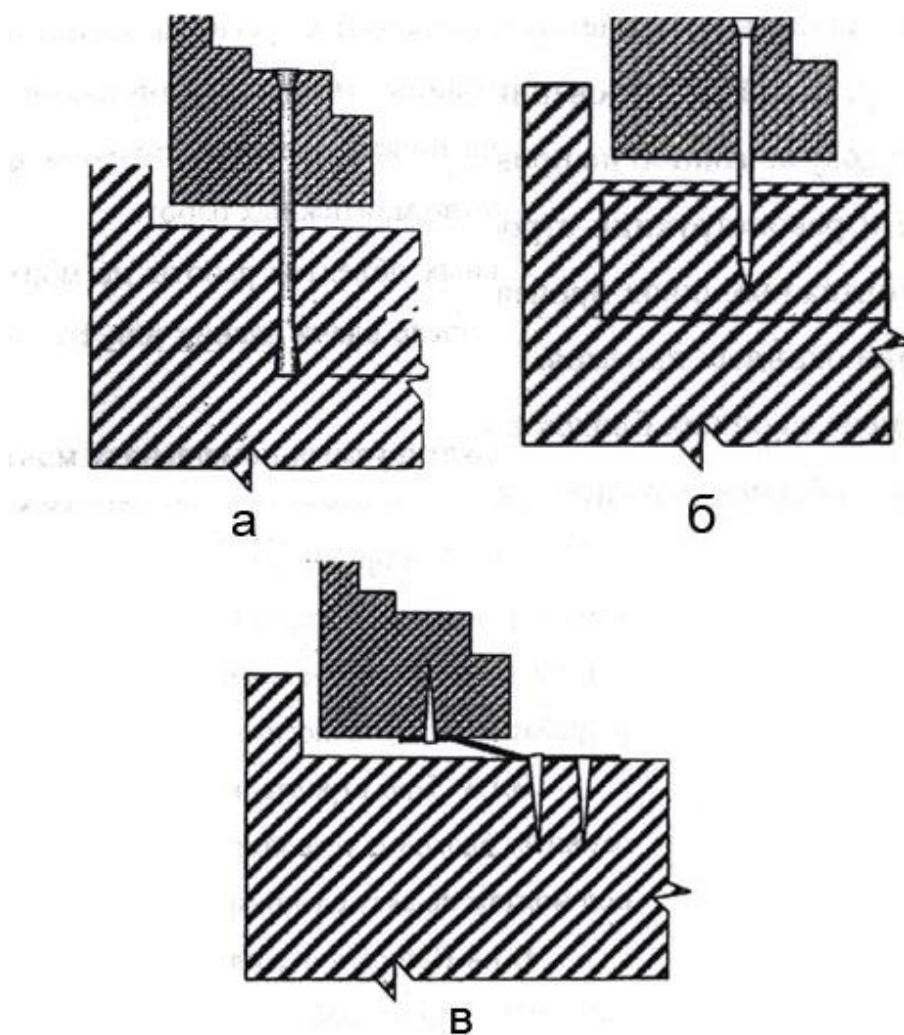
Схеми кріплення віконних блоків до бічних укосів отворів (а — кріплення рівними дюбелями розпорів, б — кріплення будівельними шурупами, в — кріплення за допомогою гнучких анкерних пластин)
